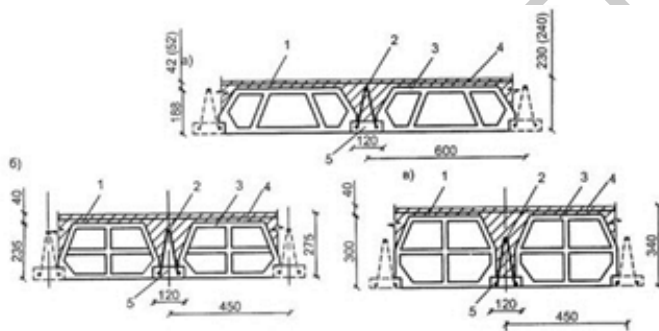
Конструктивный вид сборно-монолитных перекрытий «ДАХ»:
